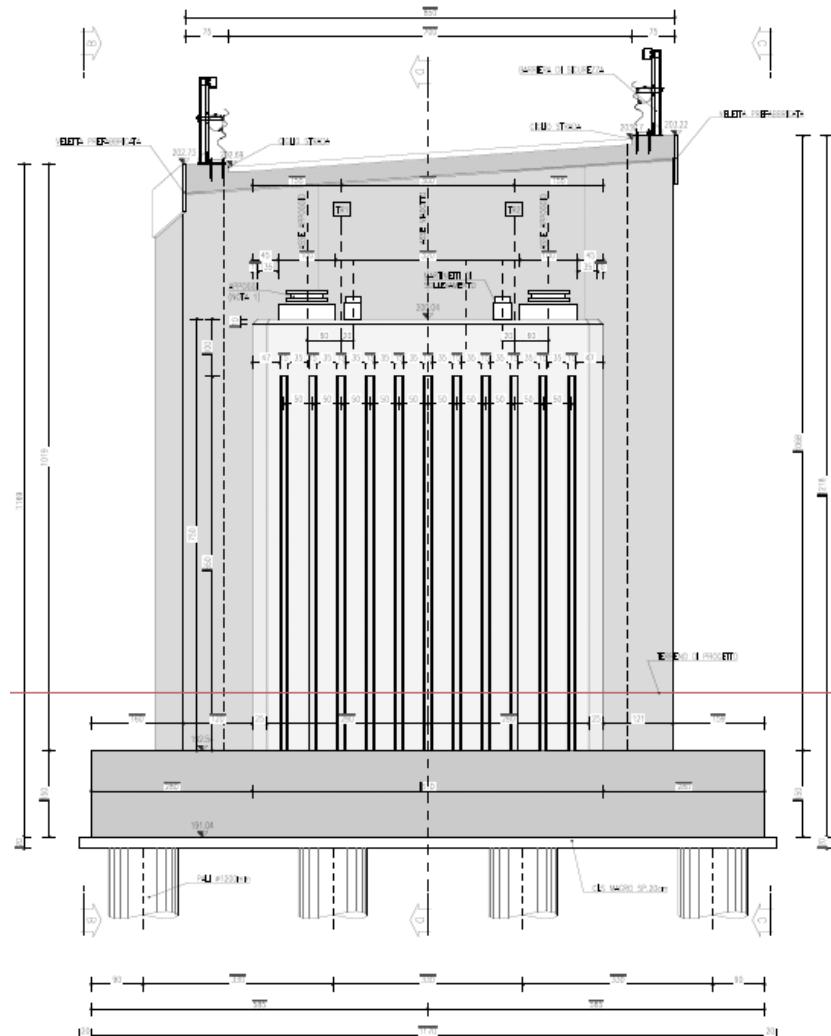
Spalla 1 – carpenteria elevazioni
